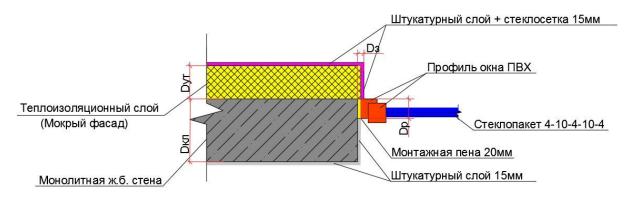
Расчетная схема для ELCUT 6.0 (Монолитная стена, мокрый фасад)
